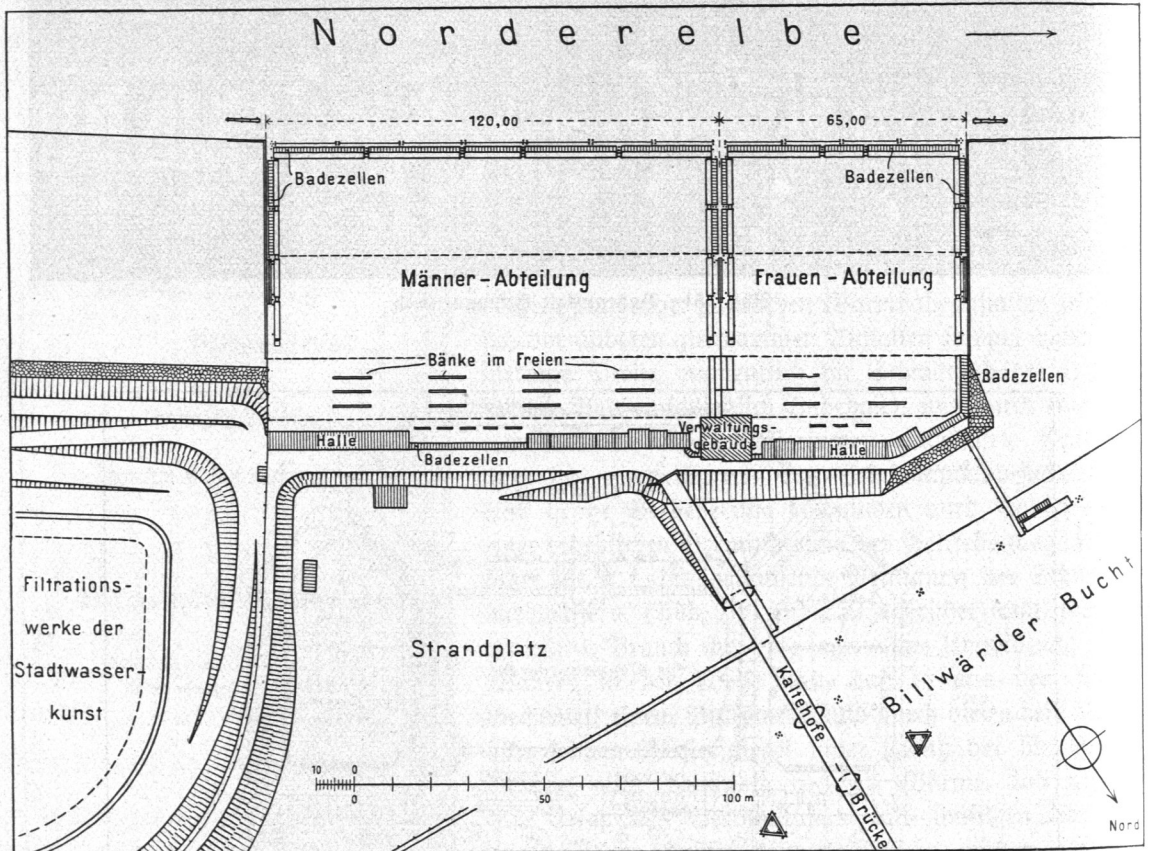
Elbbadanstalt auf Kaltehofe, Lageplan.
